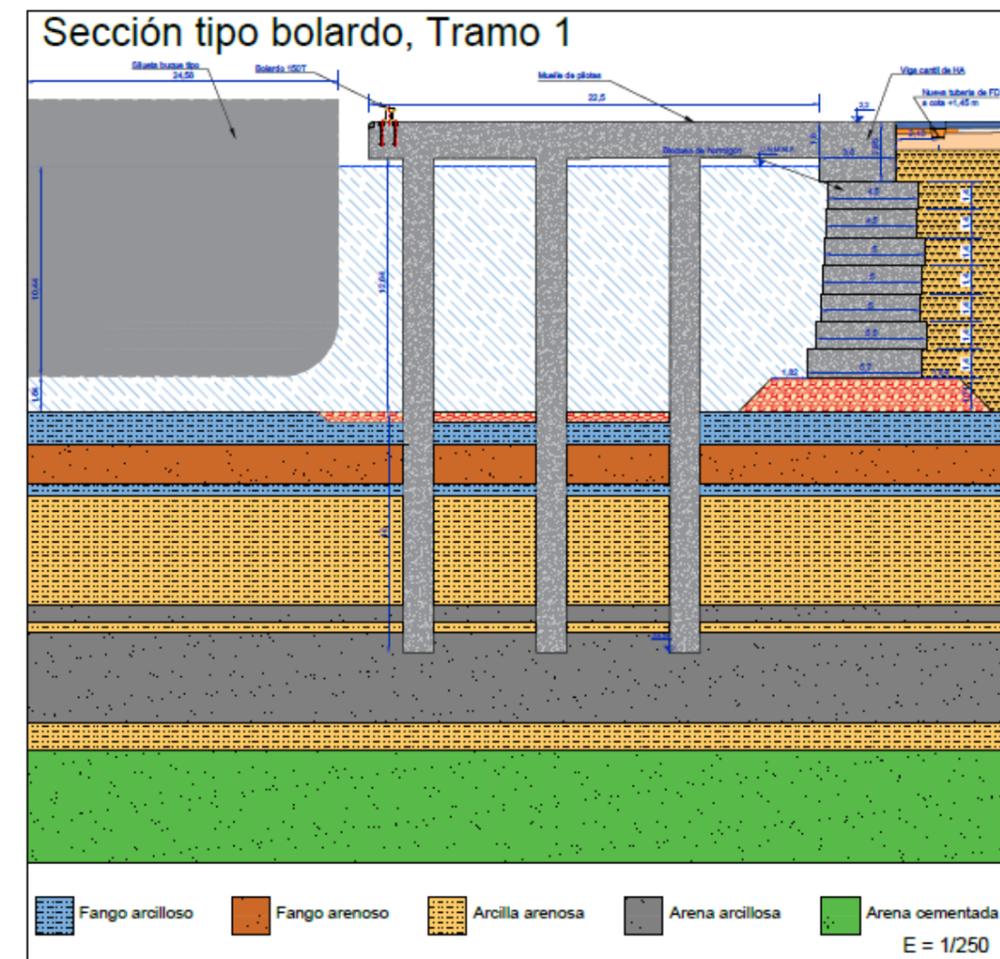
Sección tipo Tramo 1 de la solución proyectada.
